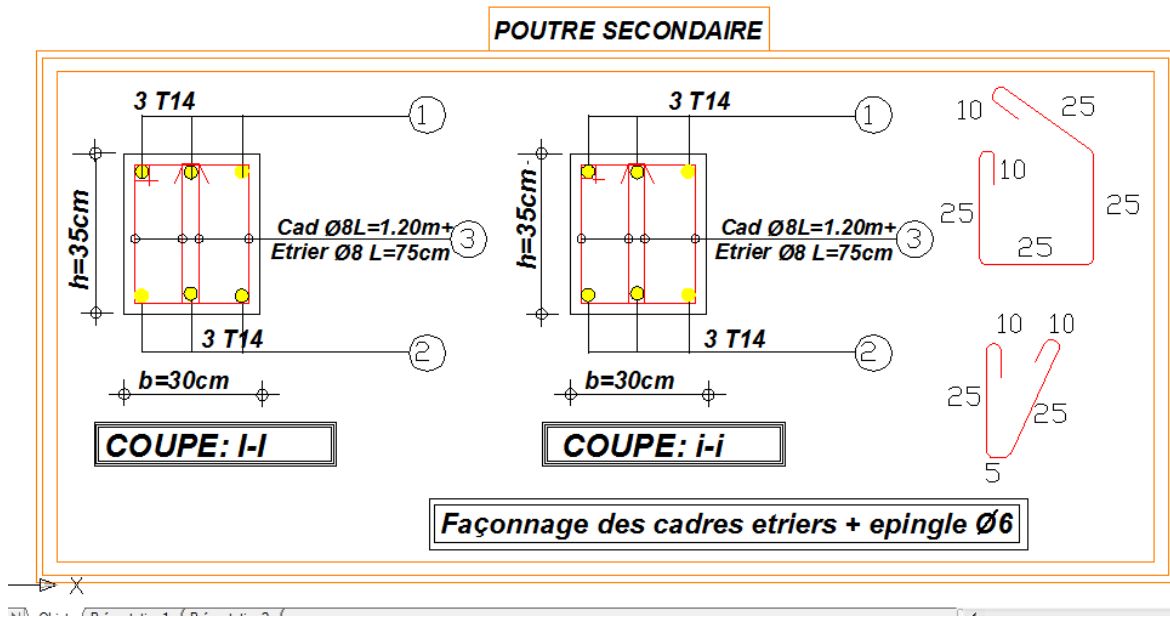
ferrailage des poutres secondaires de 8ème10 ème étage
